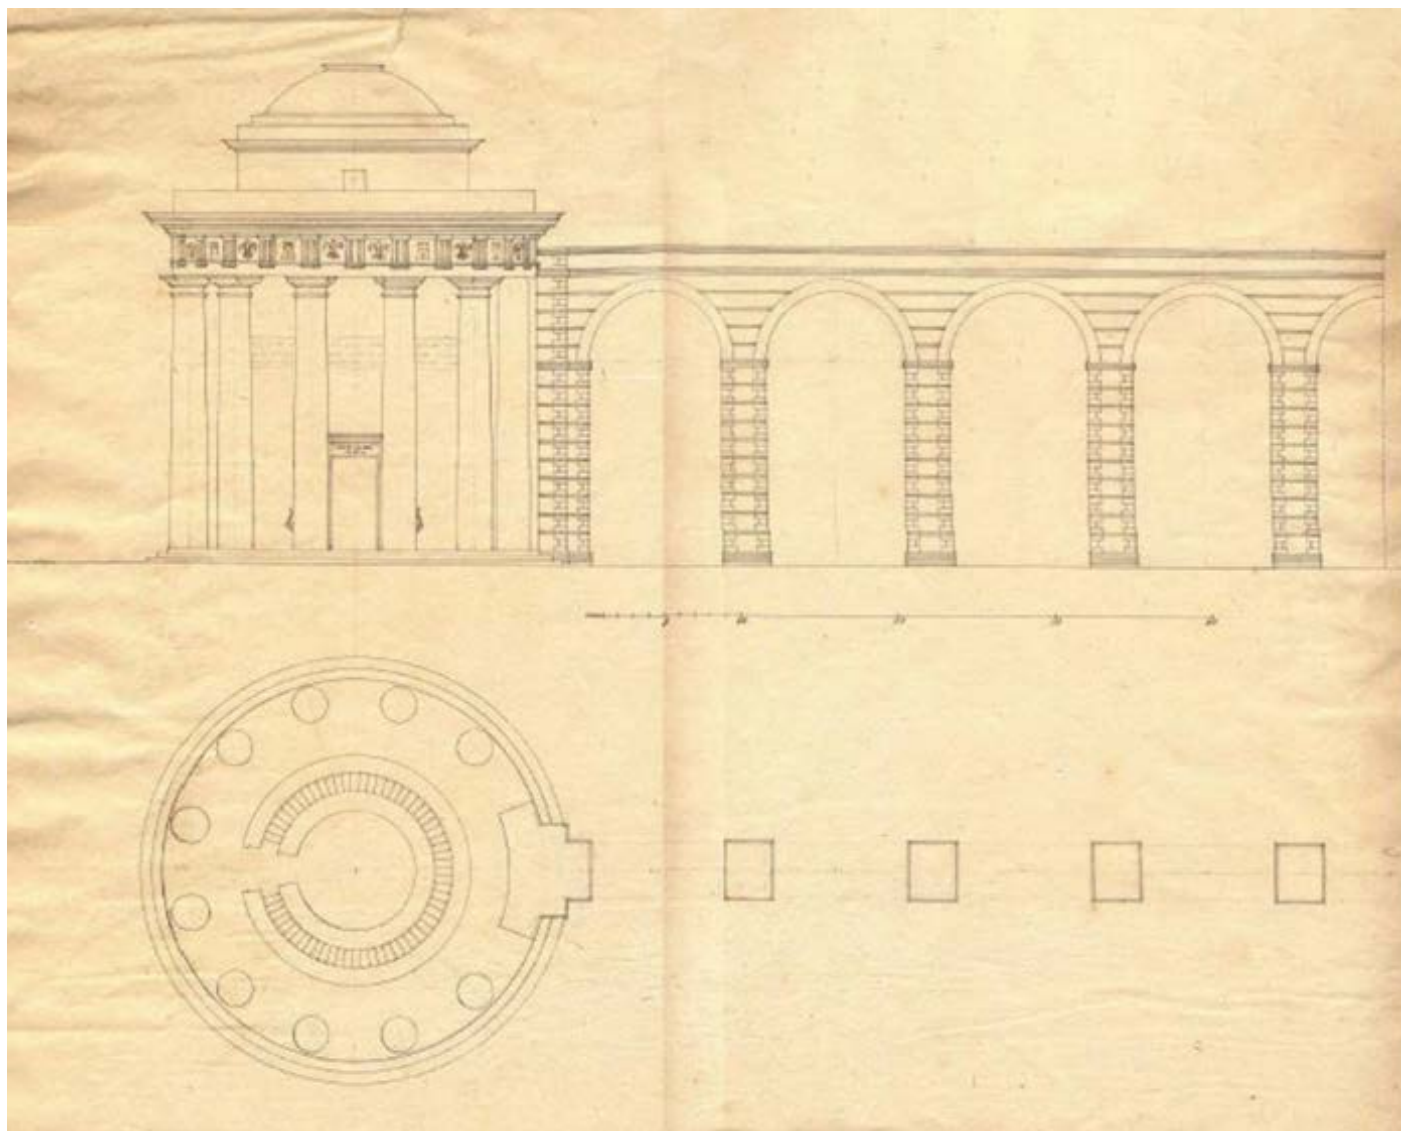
L. Nottolini, Prospetto e Pianta della parte terminale dell'Acquedotto, 1822 ca., ASLu, Fondo Nottolini, Sezione Disegni, n. 1027.
